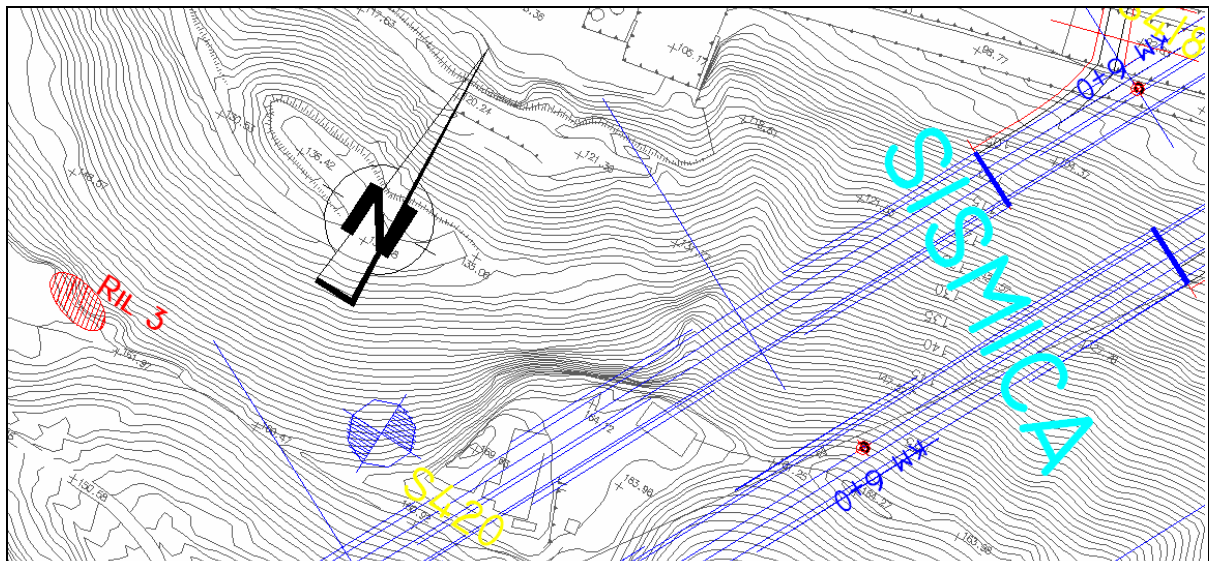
Ubicazione in planimetria dell'affioramento oggetto del rilievo geostrutturale
